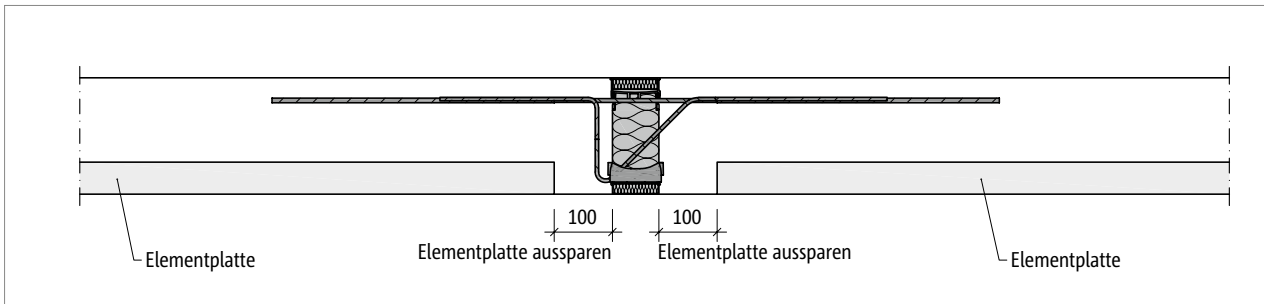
Schöck Isokorb® T Typ KL: Einbau in Verbindung mit Elementplatten, Druckfuge deckenseitig und balkenseitig
